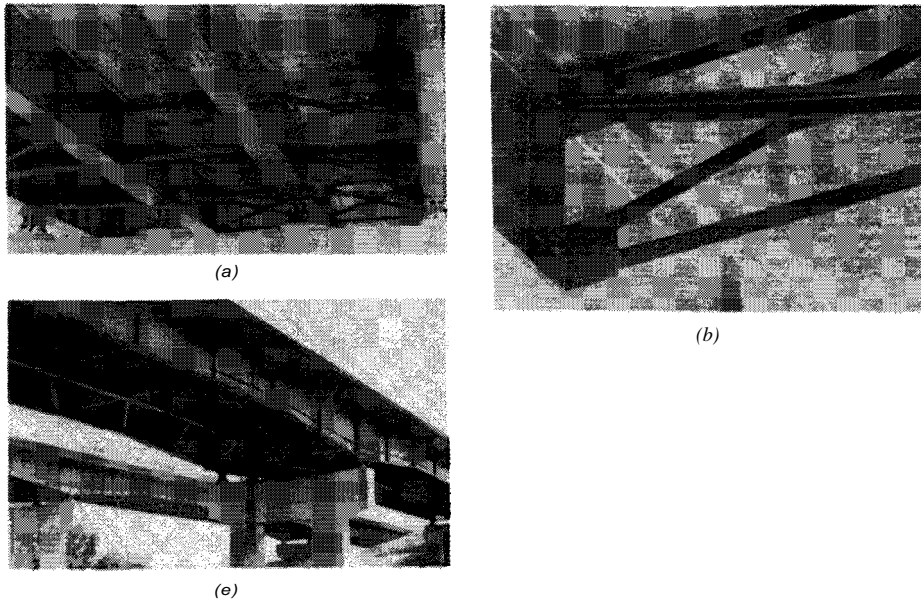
Contraventeo longitudinal y transversal. Nótese el uso de atiesadores verticales y longitudinales. El puente que está detrás en (e) es más viejo y usa construcción remachada, mientras que el puente que está en primer término está todo soldado. Las tres traves soportan una calzada de cuatro vías además de las banquetas y acotamientos en ambos puentes. (a) Contraventeo transversal. (b) Detalles de fabricación. Nótese que las placas del sujetador terminal están soldadas tanto al alma como al patín. En los puentes continuos estas placas proveen puntos de soporte para el patín. (e) Uso de contraventeo tanto transversal como longitudinal en la armadura. Nótese el atiesador longitudinal a lo largo del patín a compresión, donde hit_w resulta excesiva.
